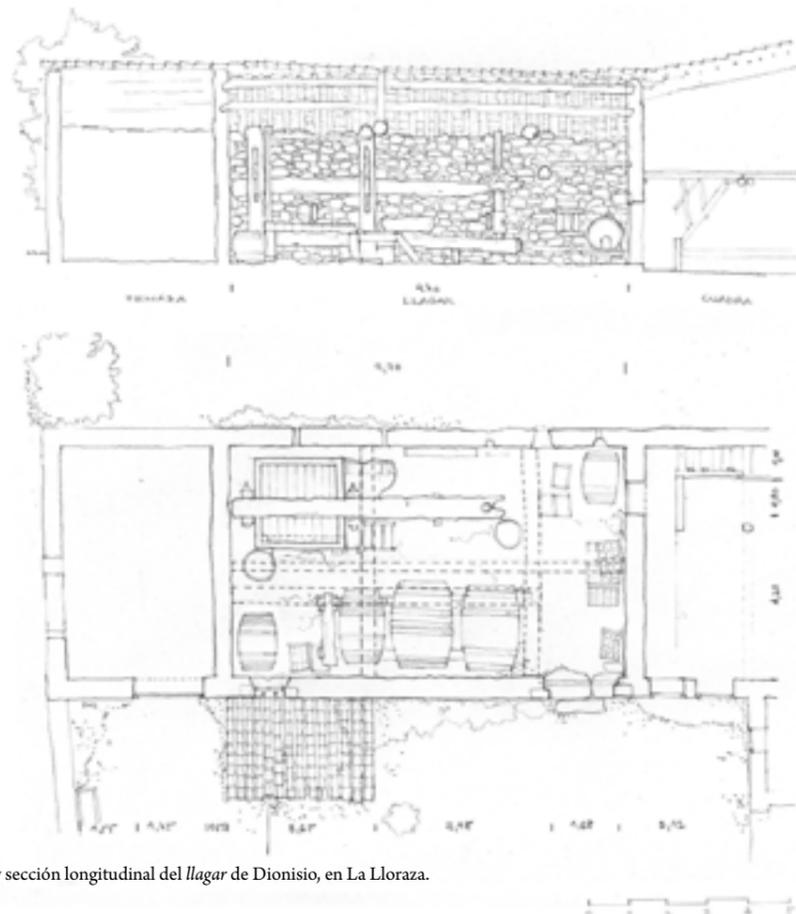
Planta y sección longitudinal del *llagar* de Dionisio, en La Lloraza.
